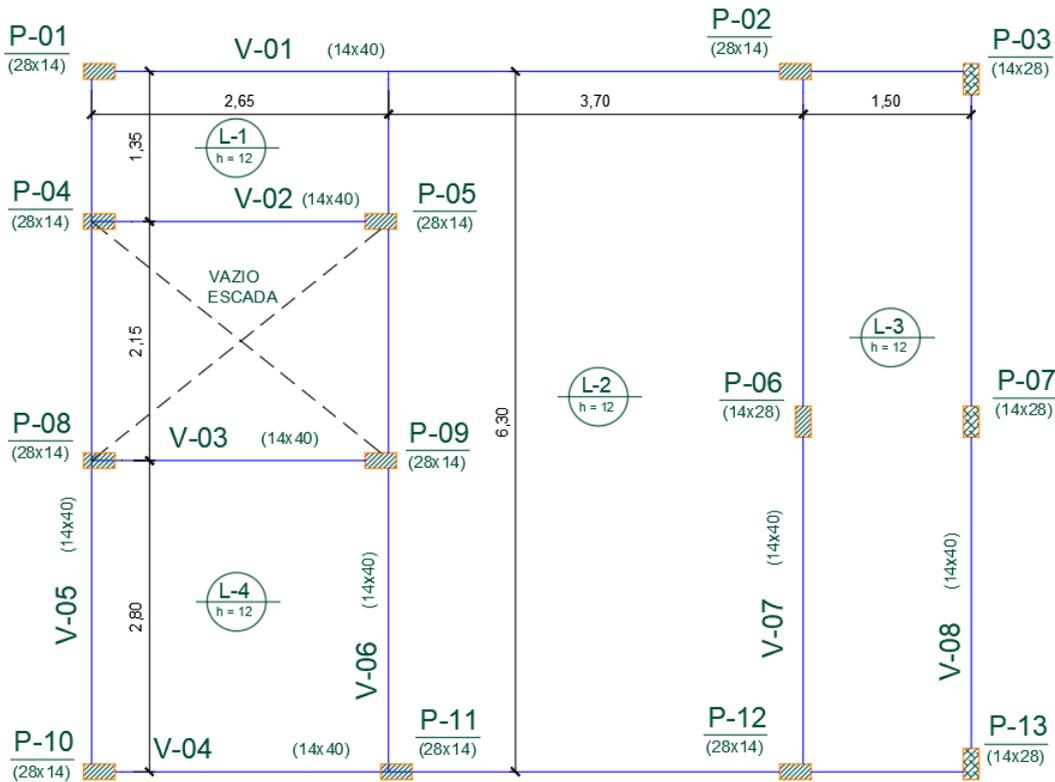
Esquema Estrutural das Lajes Maciças do Pavimento Piso Superior.
